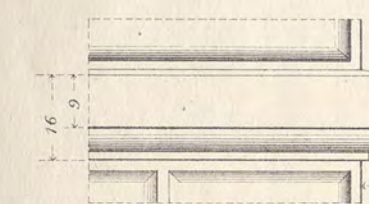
<sup>a</sup> Cimasa del parapetto del 1° piano.
